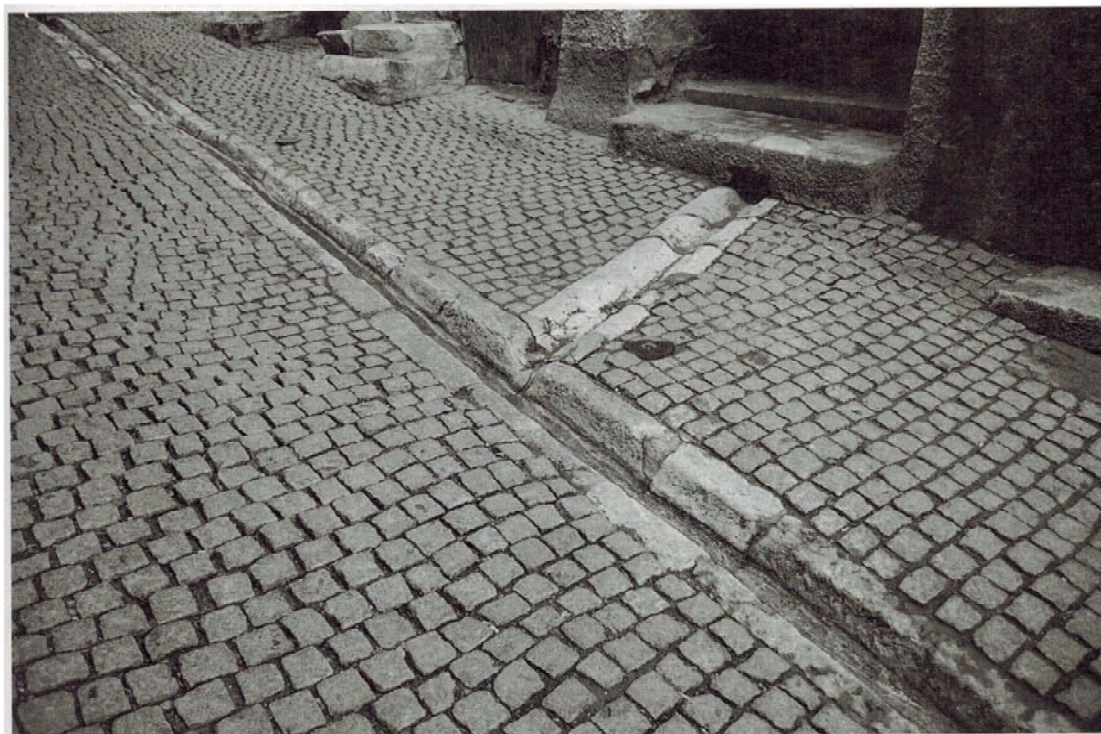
Briançon (Francia). Pavimentazione in selciato e canale di raccolta, in pietra, a cielo aperto. Vie cittadine con sezione trasversale concava.
